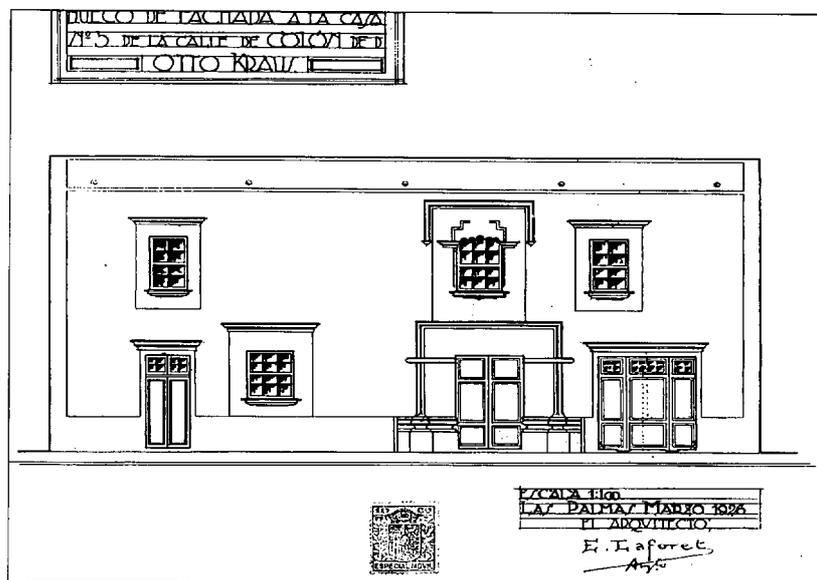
E. LAFORET: Fachada Casa n.º 5. C/. Colón. Plano del A.H.P.L.P.
